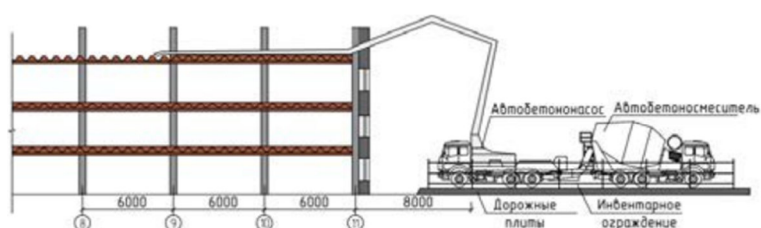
Укладка бетонной смеси в перекрытие автобетононасосом
